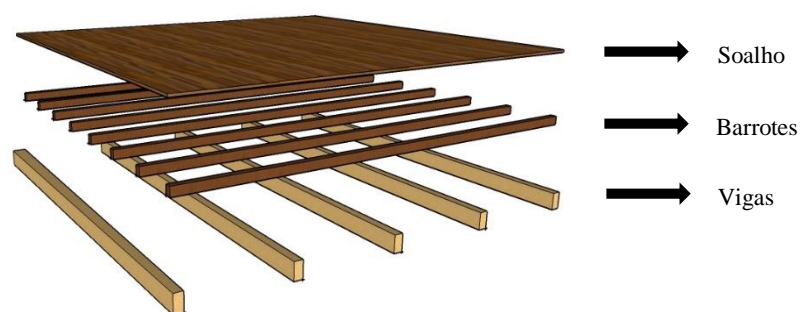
Esquema das camadas superiores de pavimentos de madeira
